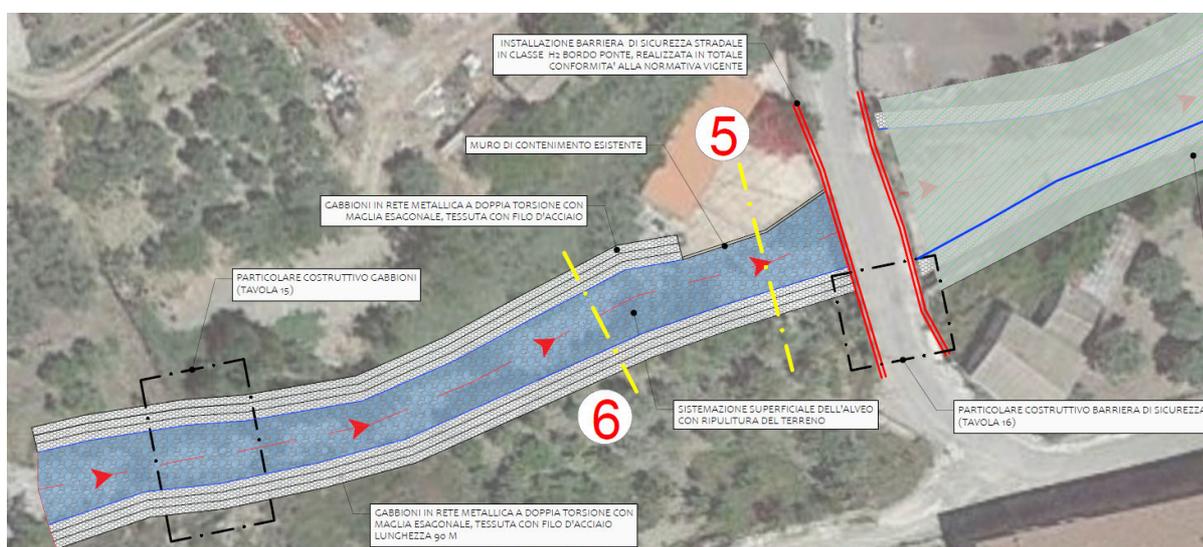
Planimetria degli interventi a monte – ramo torrente San Giacomo
